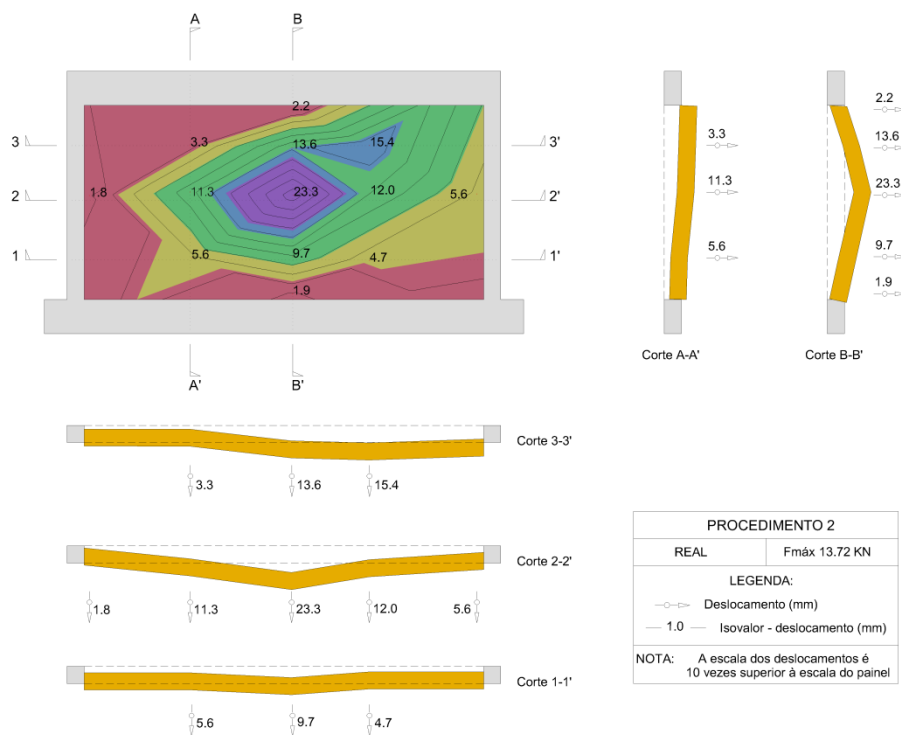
Isovalores da parede ensaiada - Procedimento 2. Ensaio fora do plano, Wall_DPA_01.
